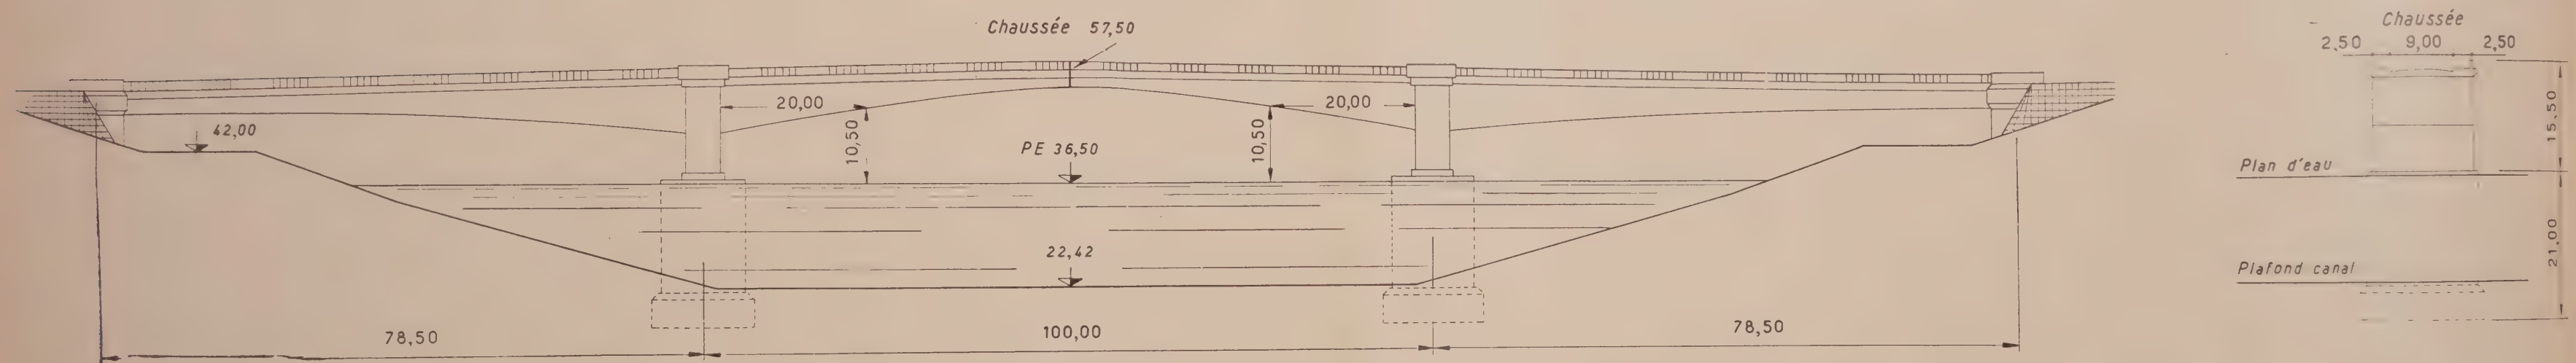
Pont de la R. N. 7 sur le canal de fuite. Élévation et coupe transversale.
